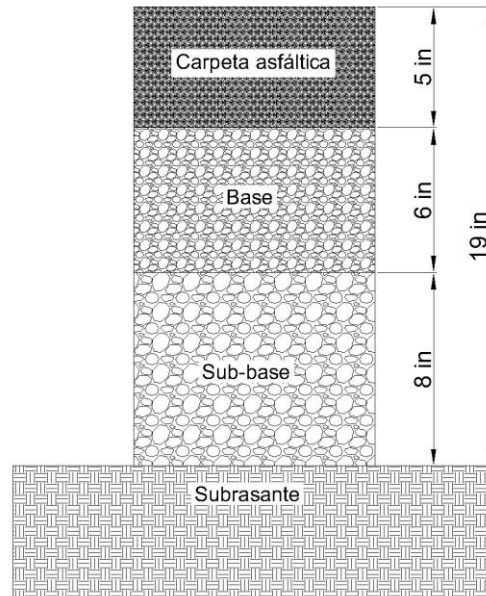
Solución estructura del pavimento primera opción – ejemplo de aplicación
